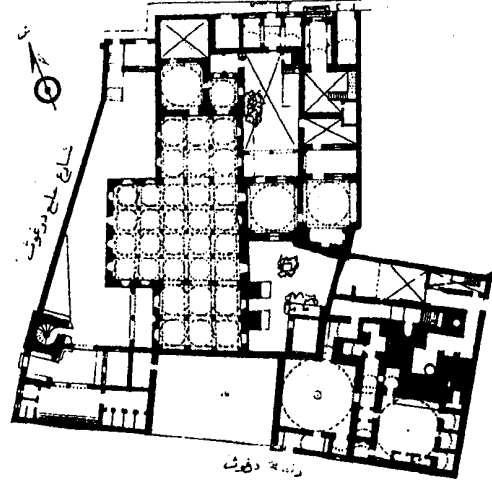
مسقط أفقي لزواية نيلوفرخاتون في أزنيق (عن Goodwin)
